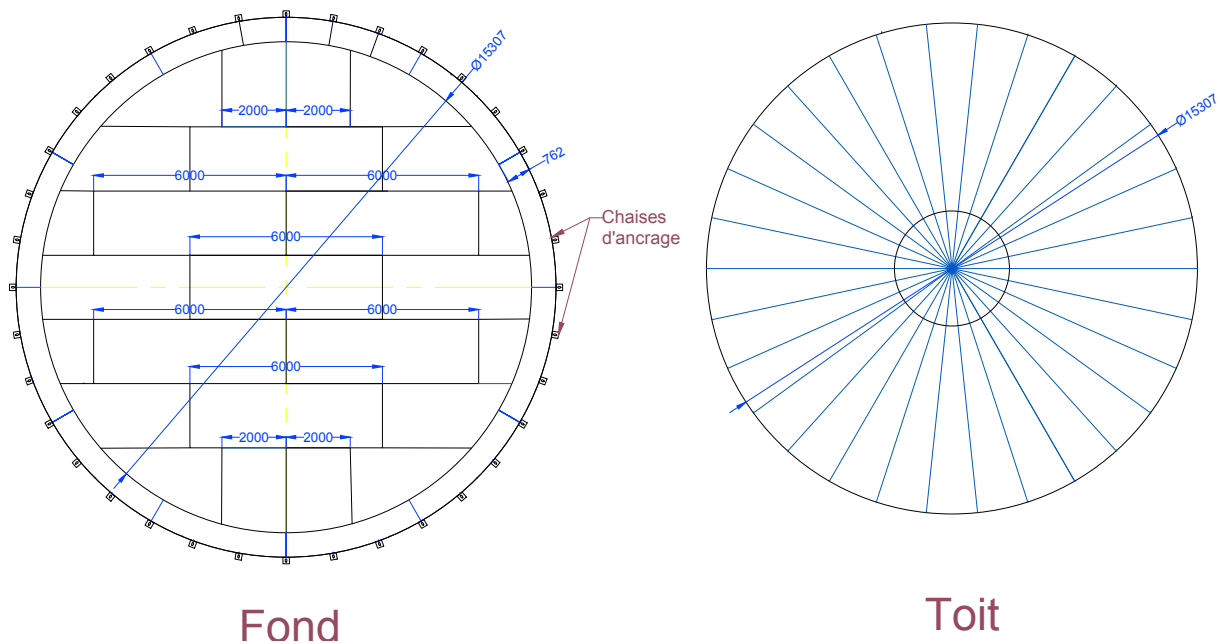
Présentation de fond et toit avec AutoCAD
